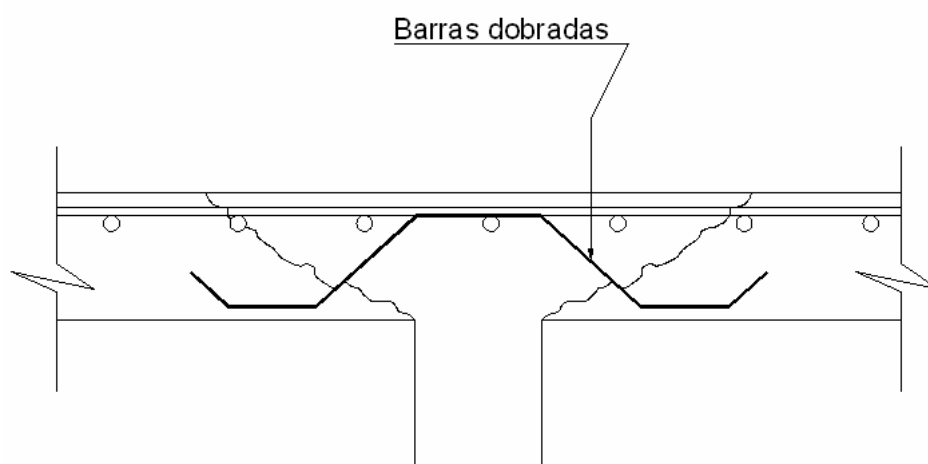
Armadura de cisalhamento utilizada por Hallgren (1996)
